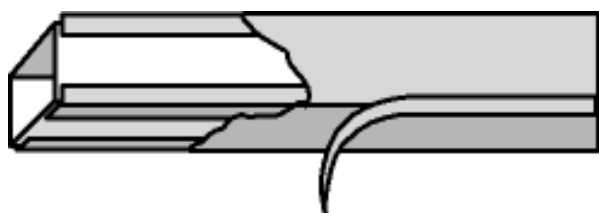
Sistema de Aislamientos Reflectivos con espaciadores longitudinales
